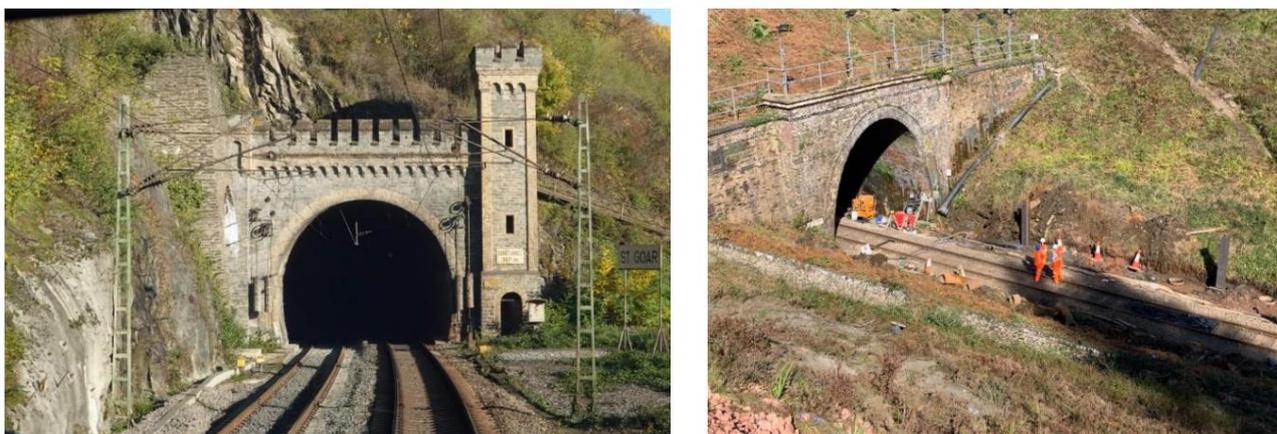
Un exemple de tunnel à voûte en maçonnerie avec une construction en pierre et en brique.
